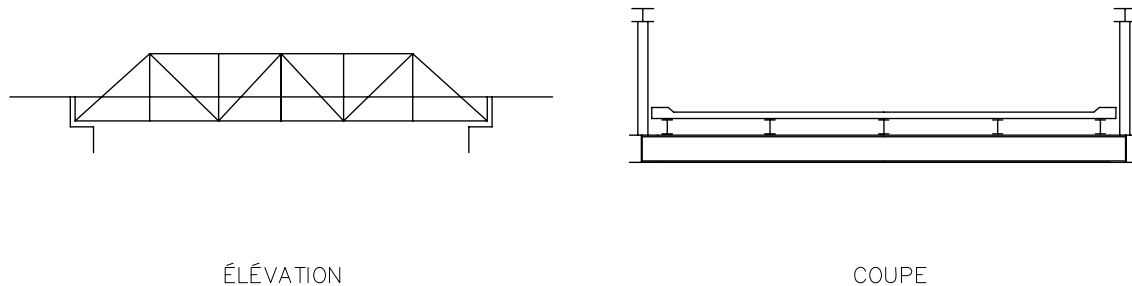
Poutre triangulée de type Pony-Warren
